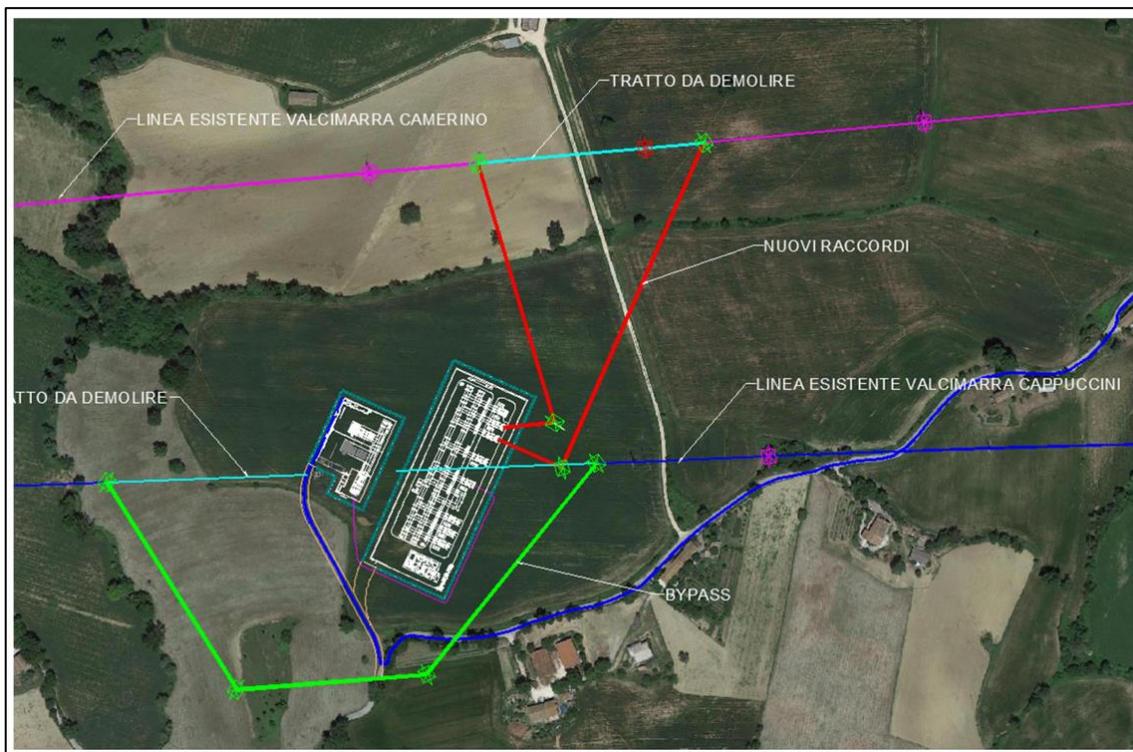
Stralcio su ortofoto della posizione della Stazione Utente, del cavidotto in AT e della Stazione di Smistamento kV
